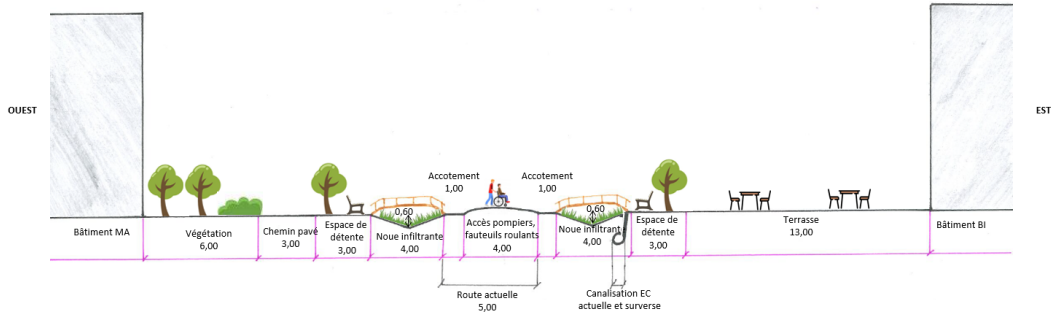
Plan de façade à façade pour le scénario 1 au niveau de la coupe 2.
